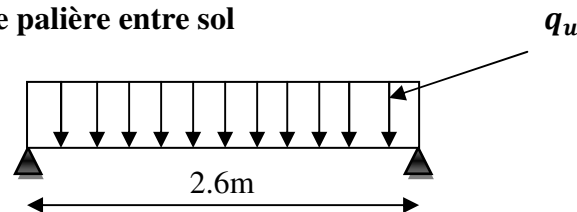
Schéma statique de la poutre palière de l'entre sol
